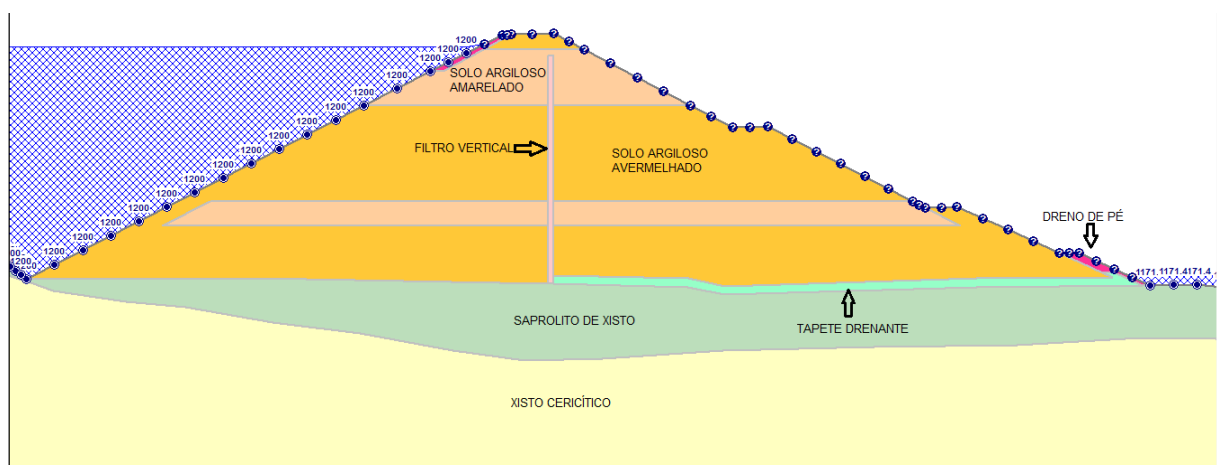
Seção típica - Projeto *As Built* da Barragem A.
